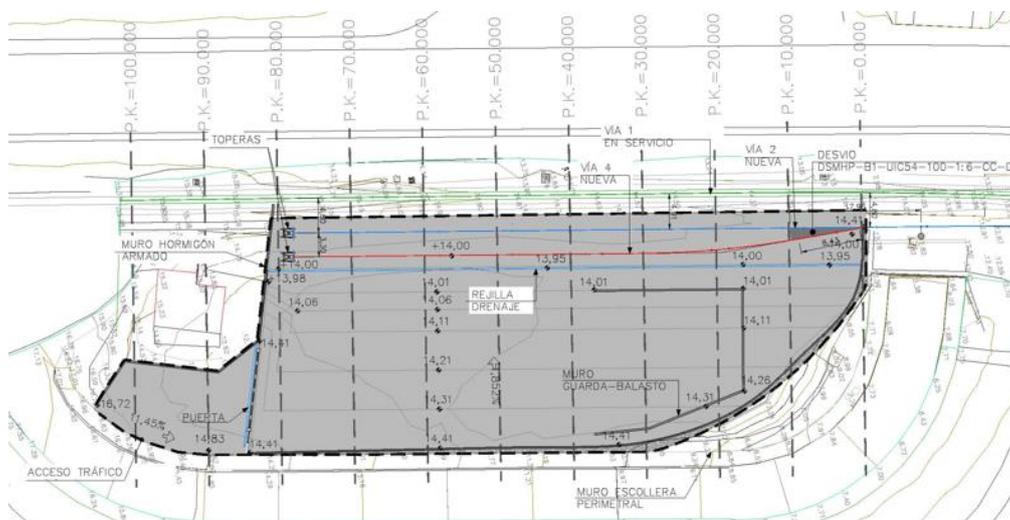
Planta de nueva área con P.P.K.K. de referencia.
